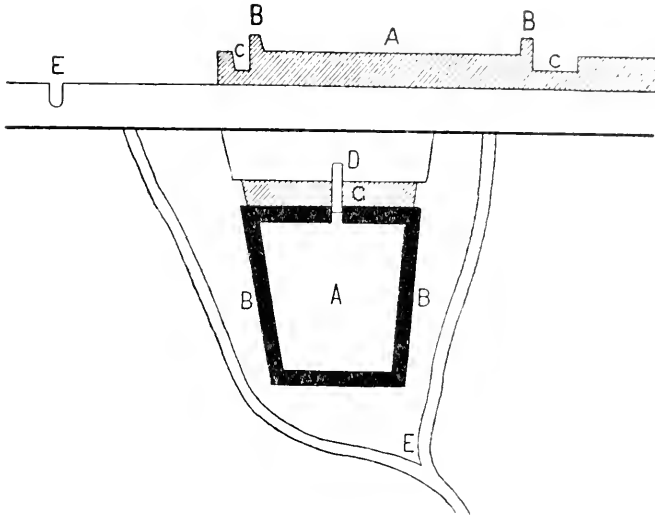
Plan de fortin (Tehashi) Aïnou Kourilien.
